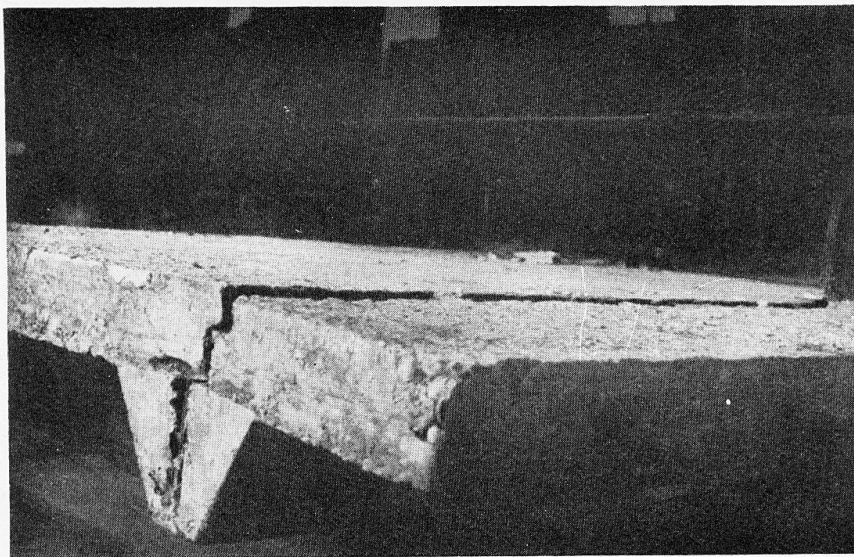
Fissure longitudinale avec déplacement de la poutre.
